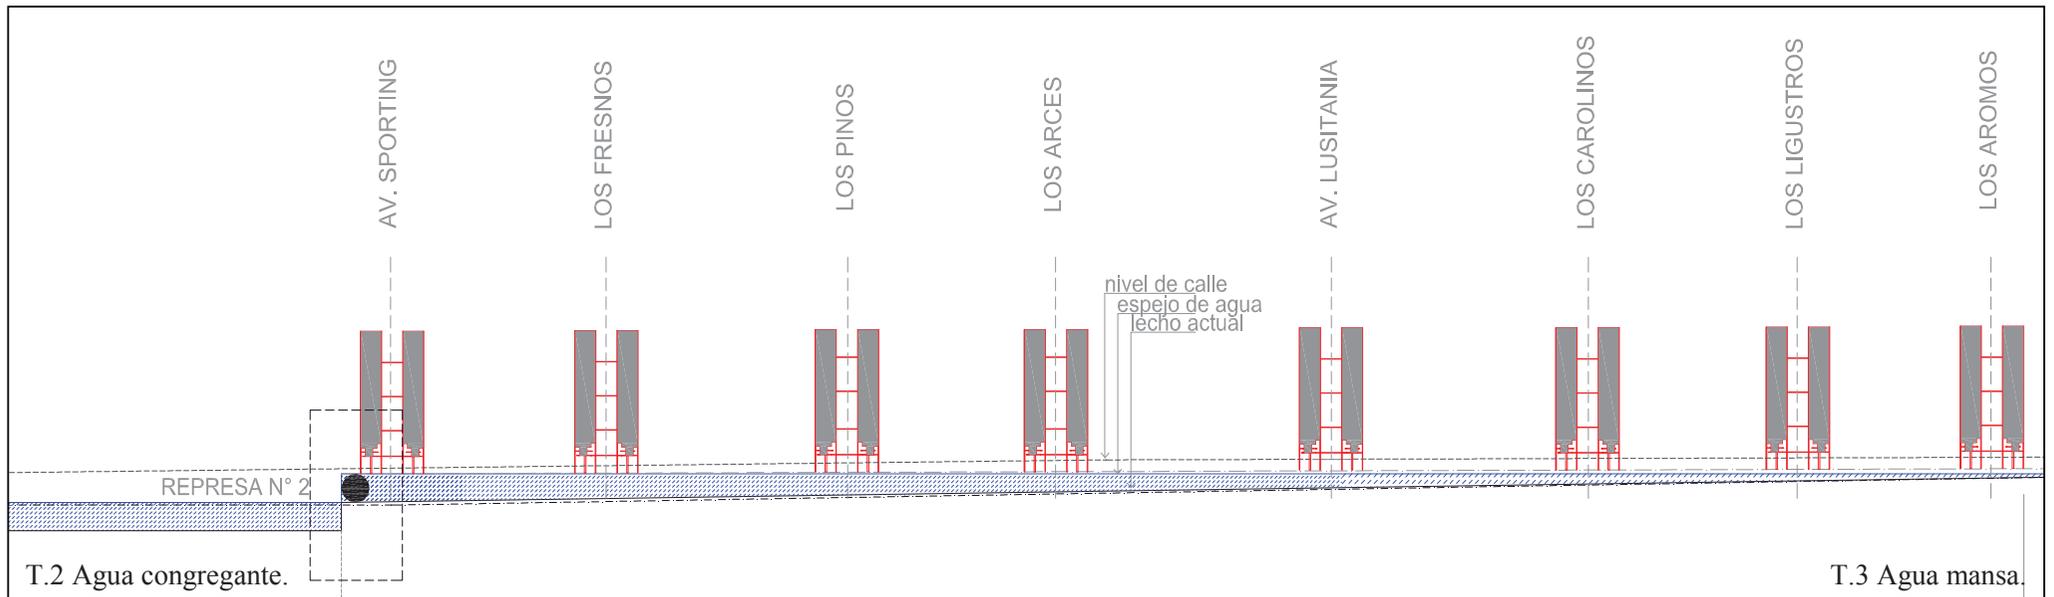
Planos Homero Latorre. Corte longitudinal tramos 3, conserva la pendiente natural con lecho pavimentado e indica los edificios y su emplazamiento frente a las calles del barrio de Miraflores.
